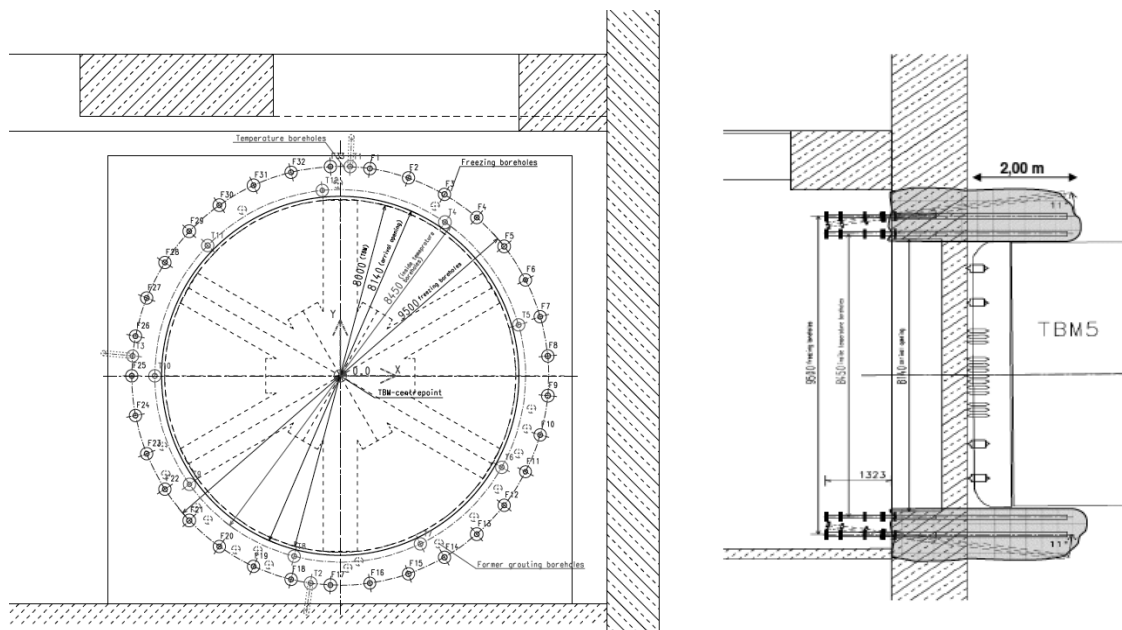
Bohrbild und geplante/ ausgeführte Tiefe der Bohrungen
